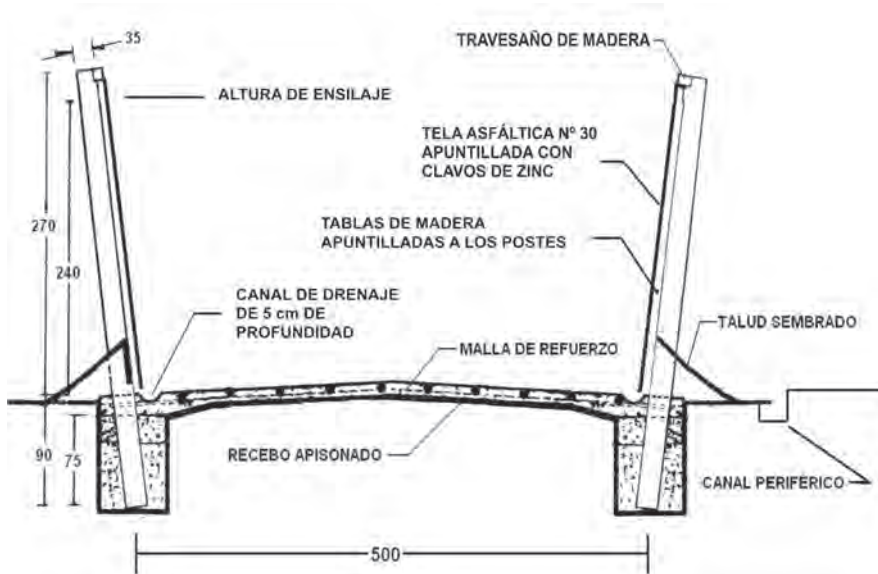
Sección transversal que enseña los principales detalles constructivos de un henil en forma de bunker (medidas en cm.).
